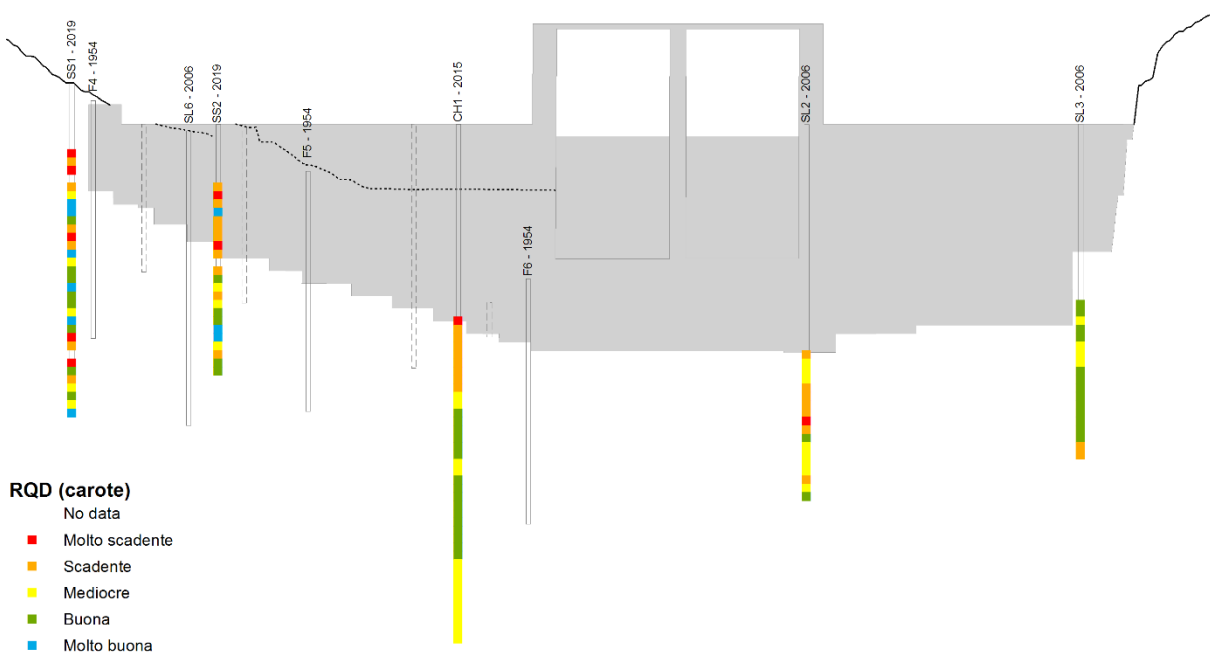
RQD lungo la sezione di imposta diga ricavato dalle analisi delle carote.
